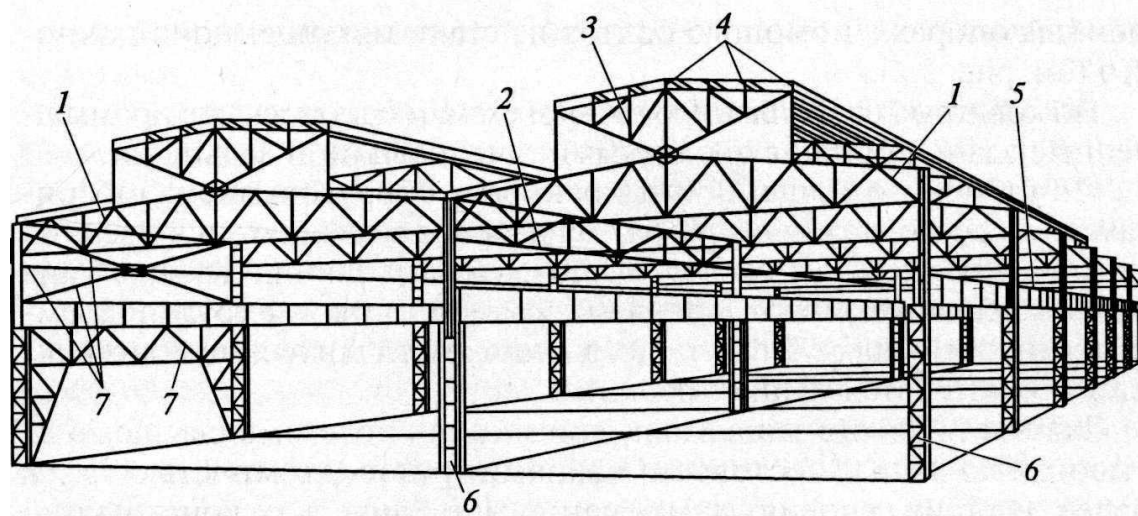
Конструкции одноэтажных промышленных зданий:
